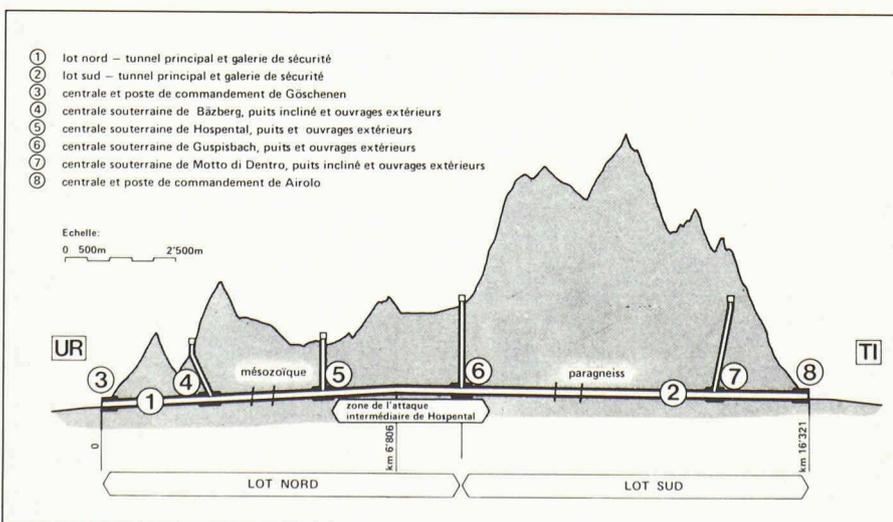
Coupe longitudinale schématique du tunnel routier du Saint-Gothard (N2).
